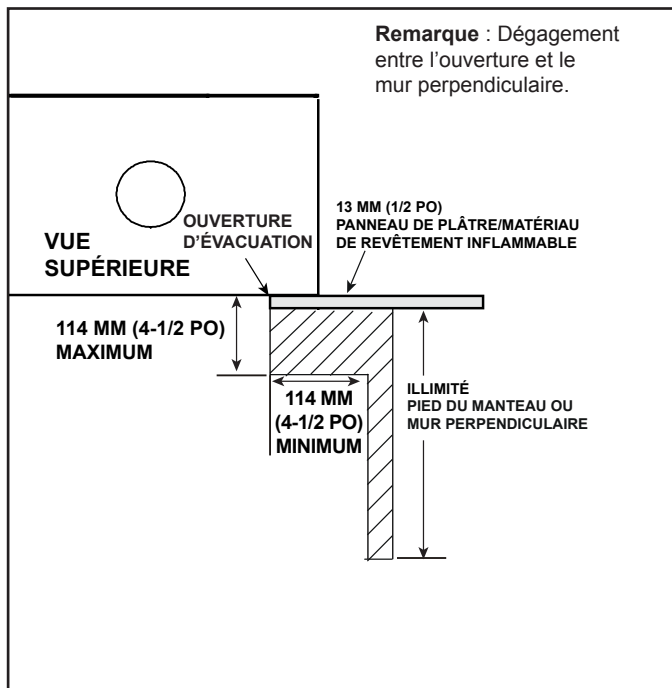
Pied du manteau de foyer ou saillies du mur
